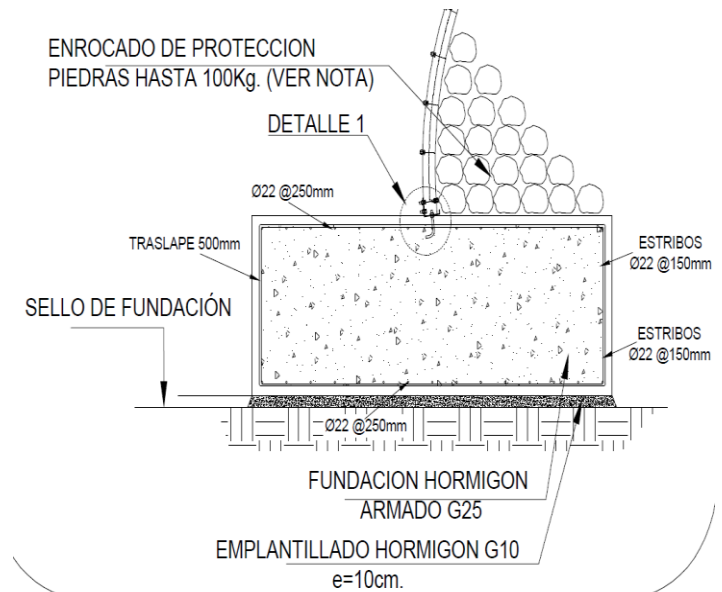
Detalle según plano de fundaciones Puente El Membrillo.
